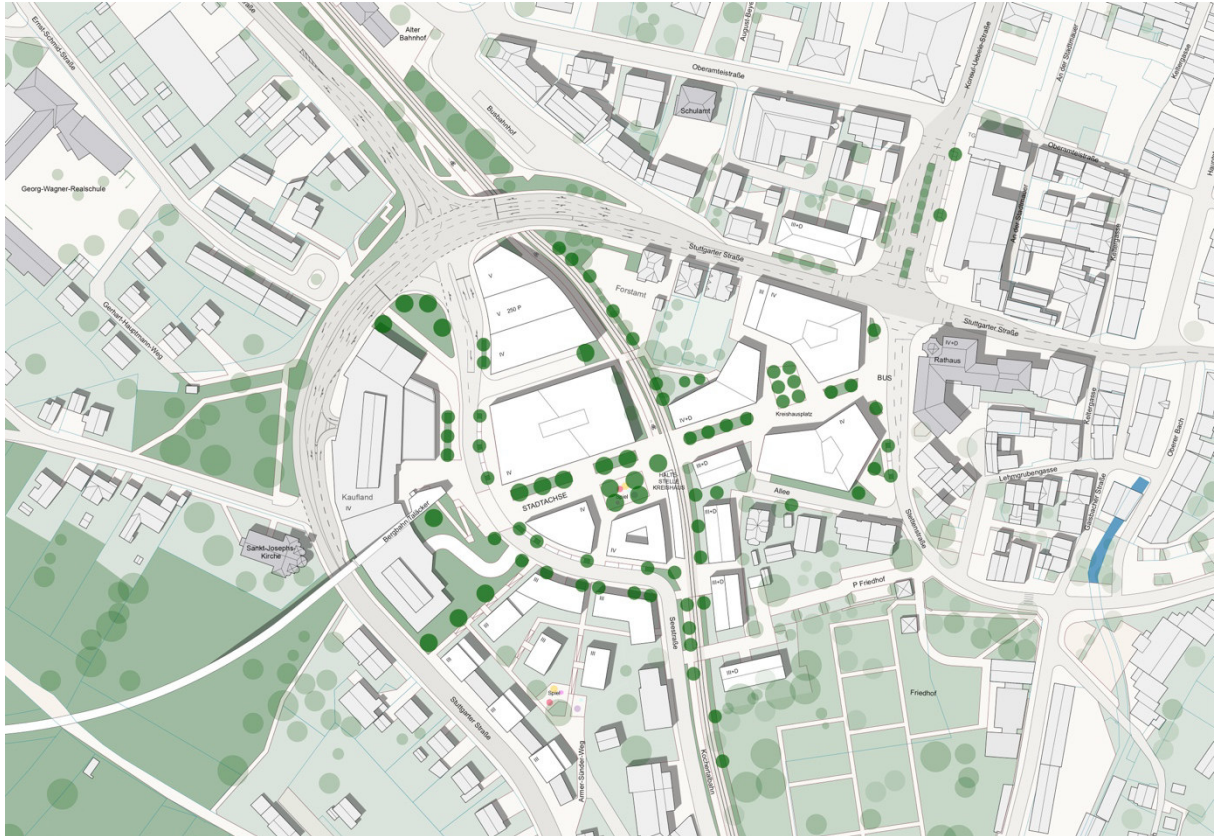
Fortschreibung Rahmenplan Stadteingang Stuttgarter Straße, August 2023
